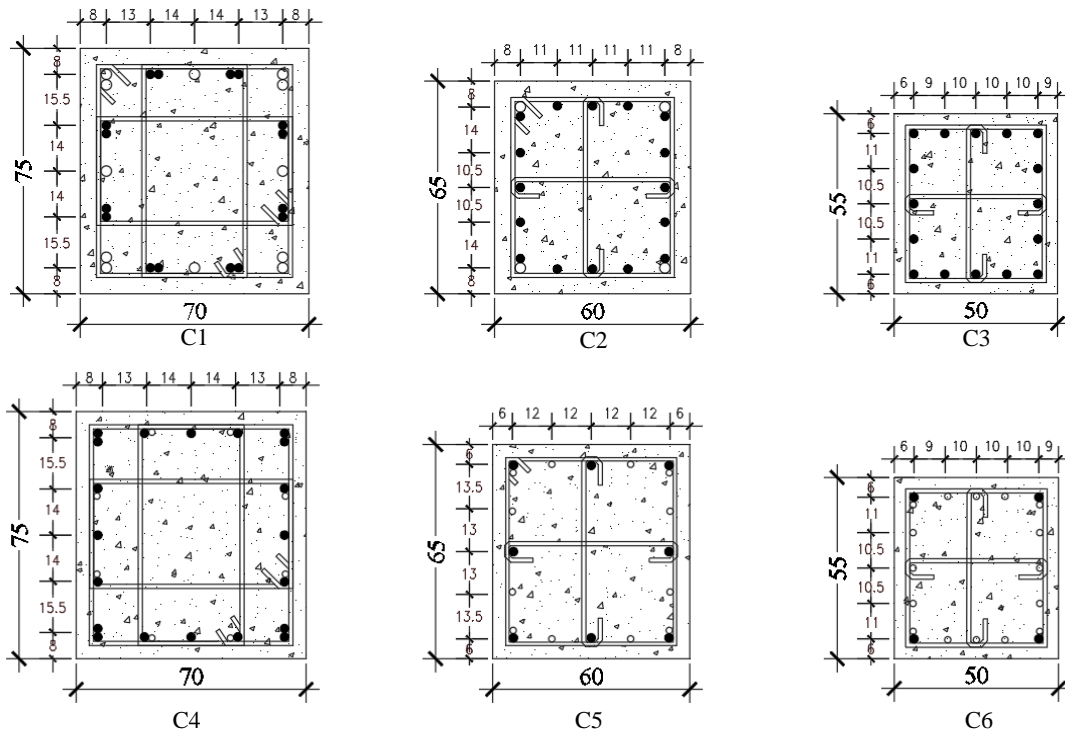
Secciones de columnas del edificio de 10 niveles.
